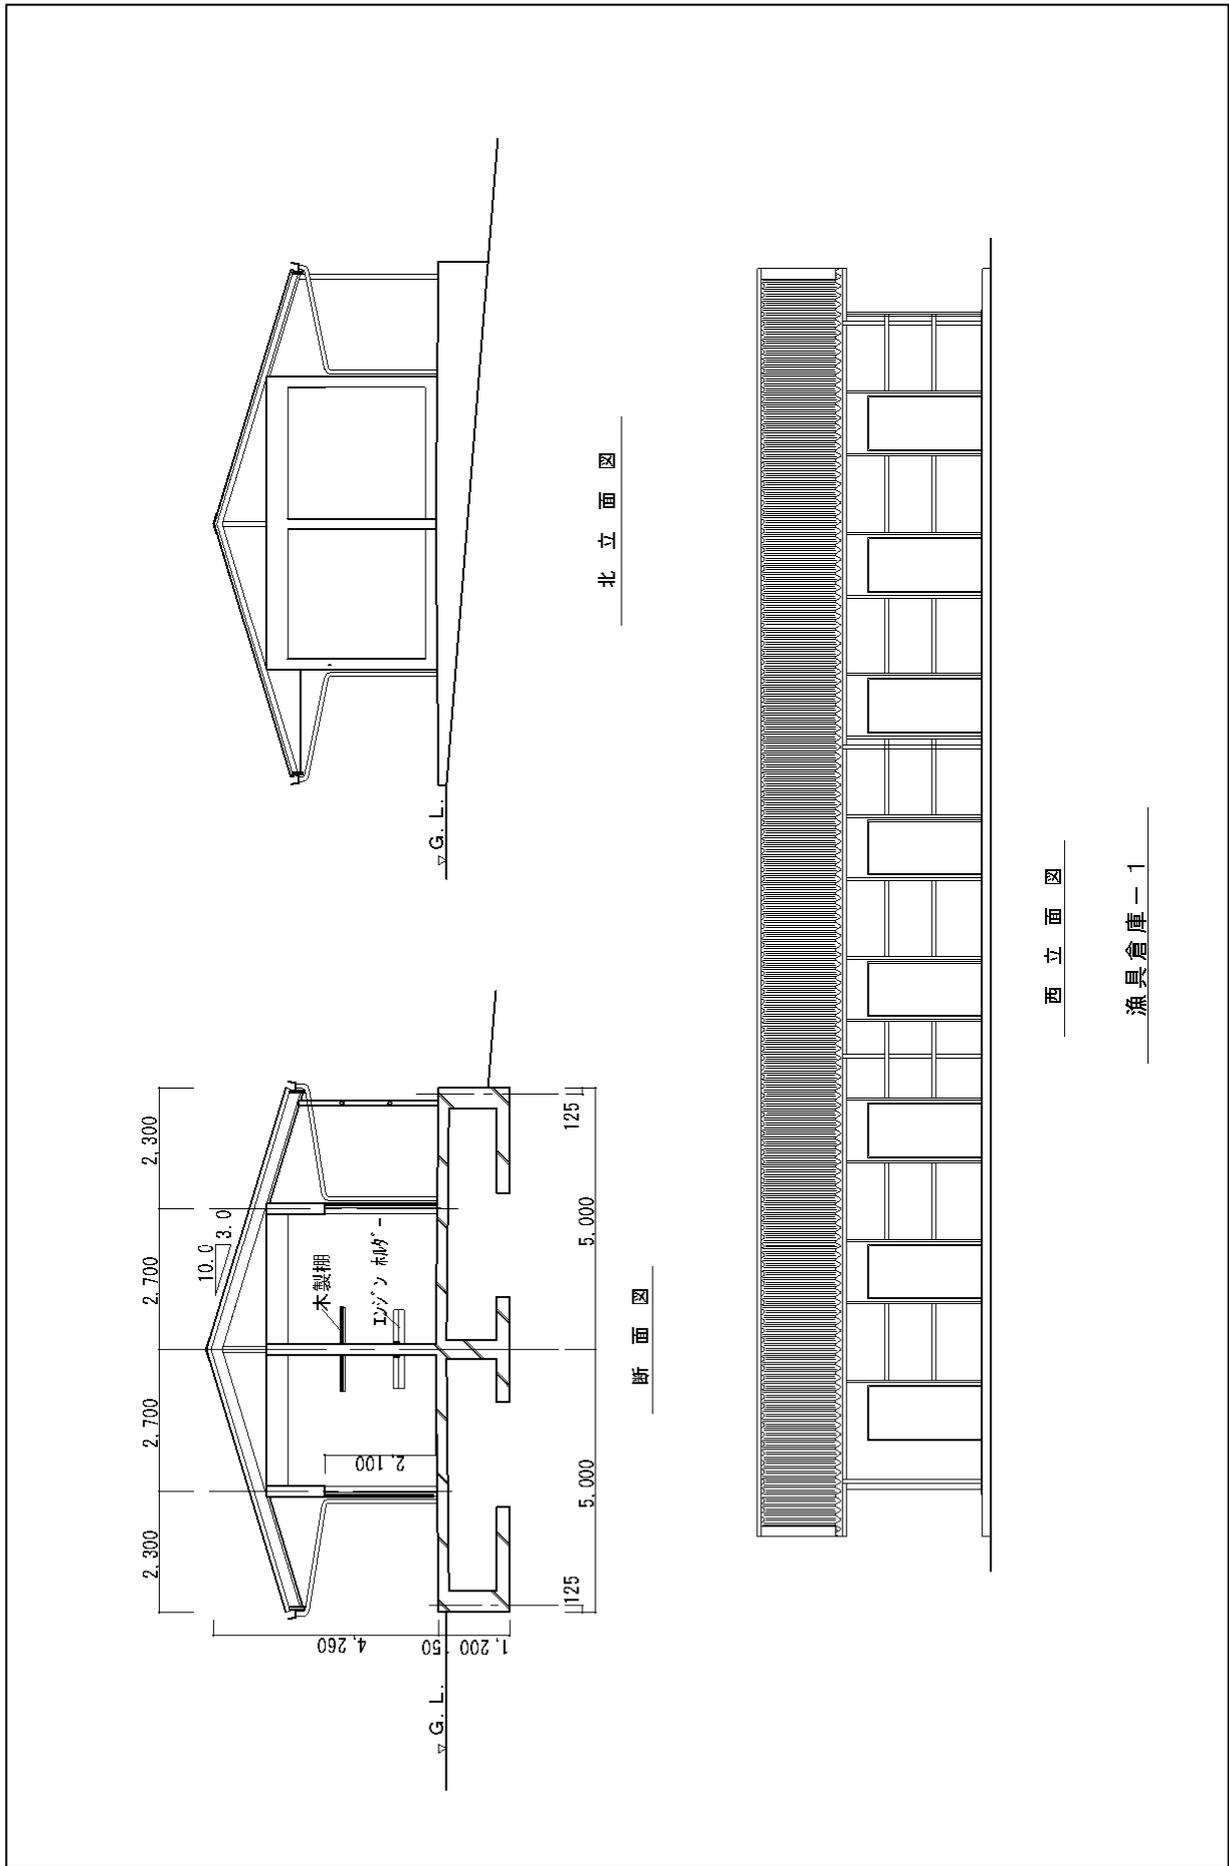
(12) 漁具倉庫 1 立面・断面图
